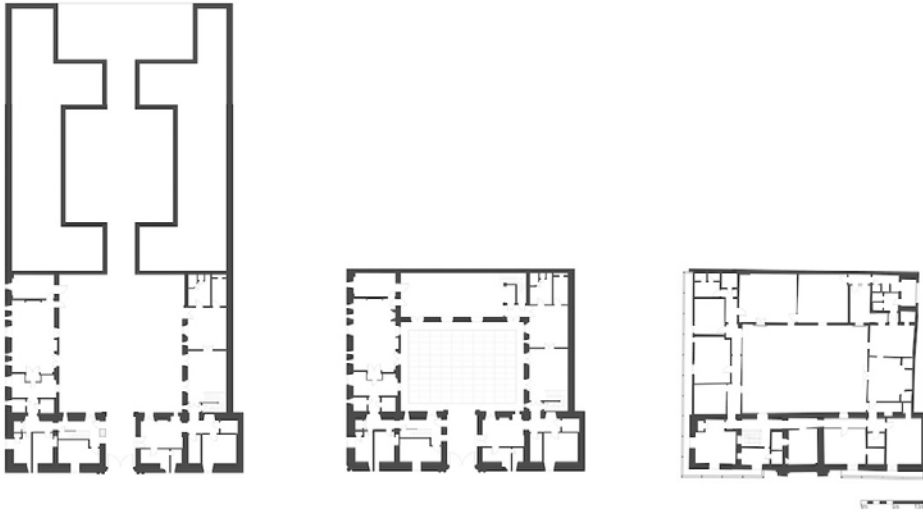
Planimetría de la Casa de Velasco. De izquierda a derecha reconstrucción planta original y 1º y 2º piso actual. Elaboración propia.
